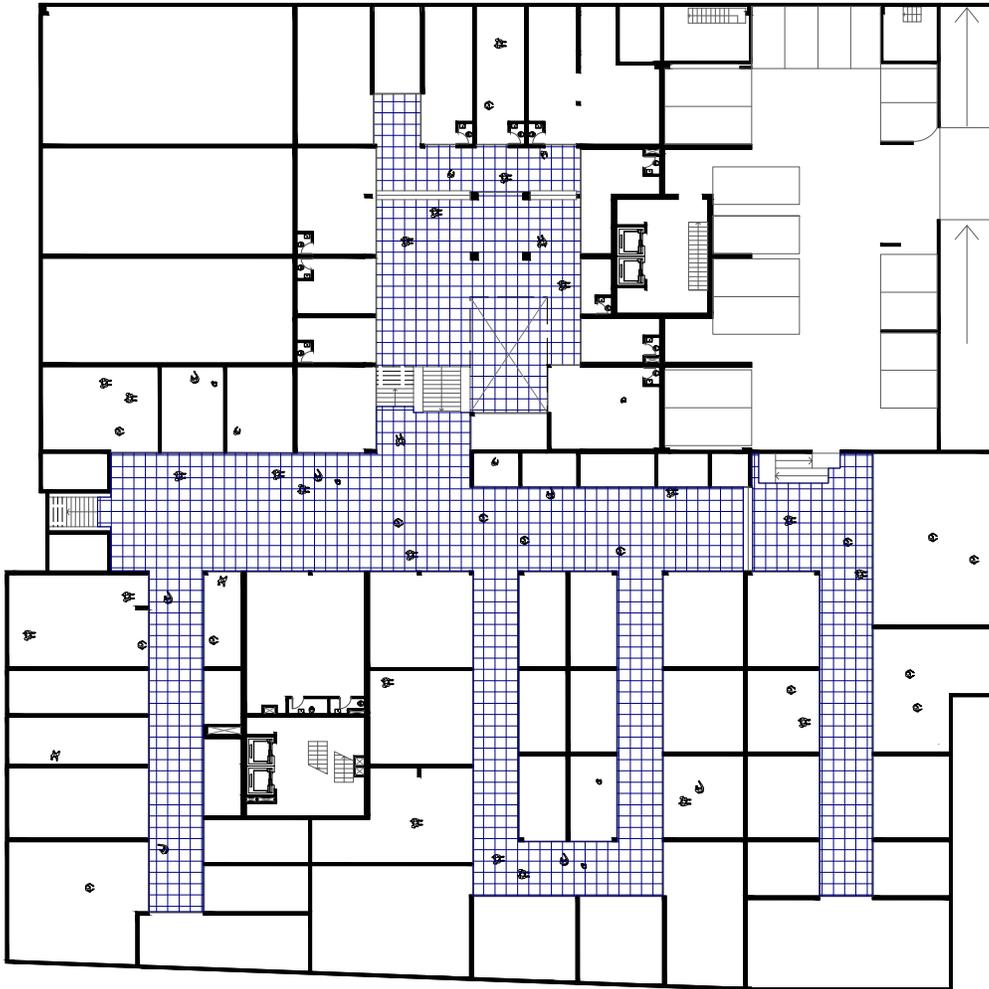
Planta Nivel Subsuelo Drugstore. Fuente: Elaboración Propia.
